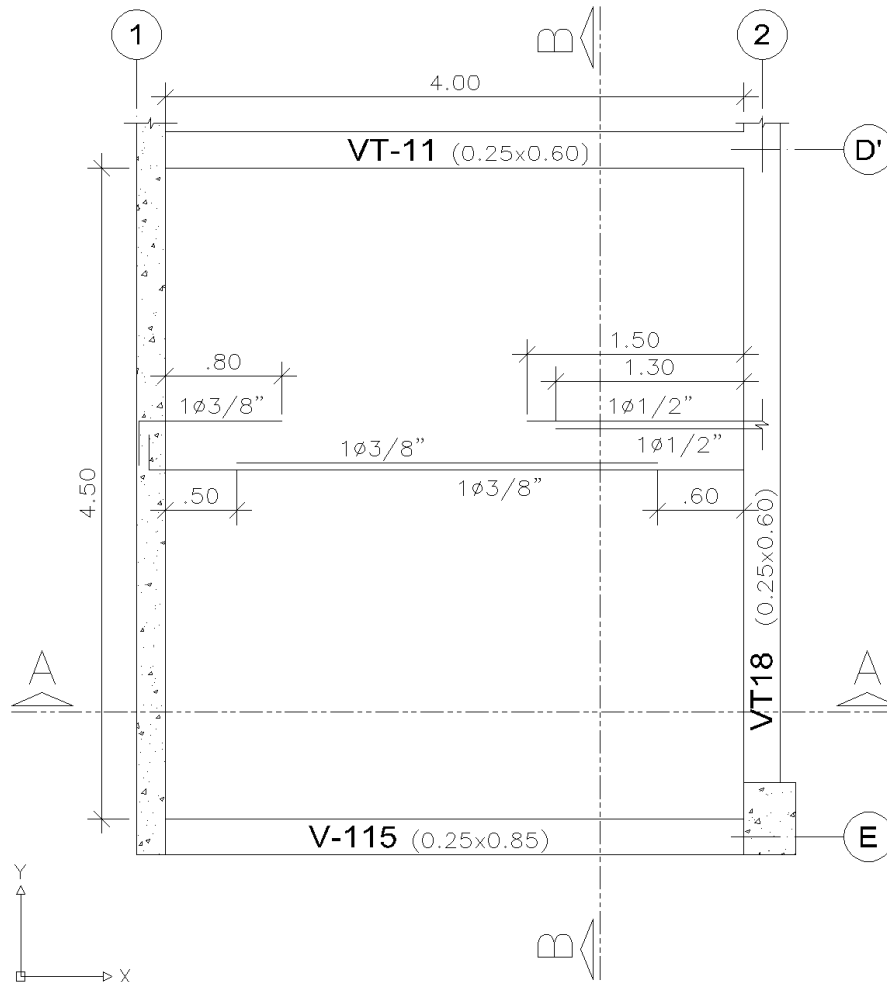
Vista en Planta del Paño de Losa Aligerada Unidireccional, Comprendida entre los Ejes 1 – 2/D' – E, del 2do Piso del Proyecto “Vivienda Multifamiliar Tudela y Varela”.
